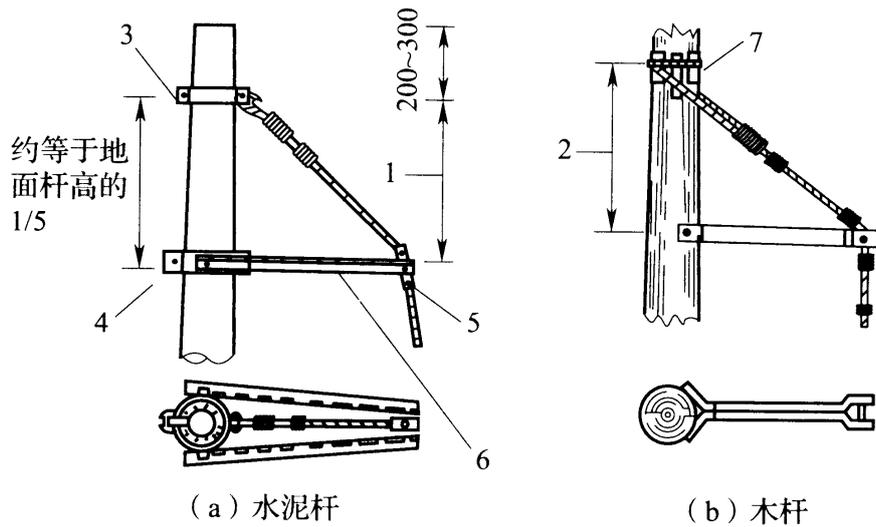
钢筋混凝土杆高桩拉线示意图
